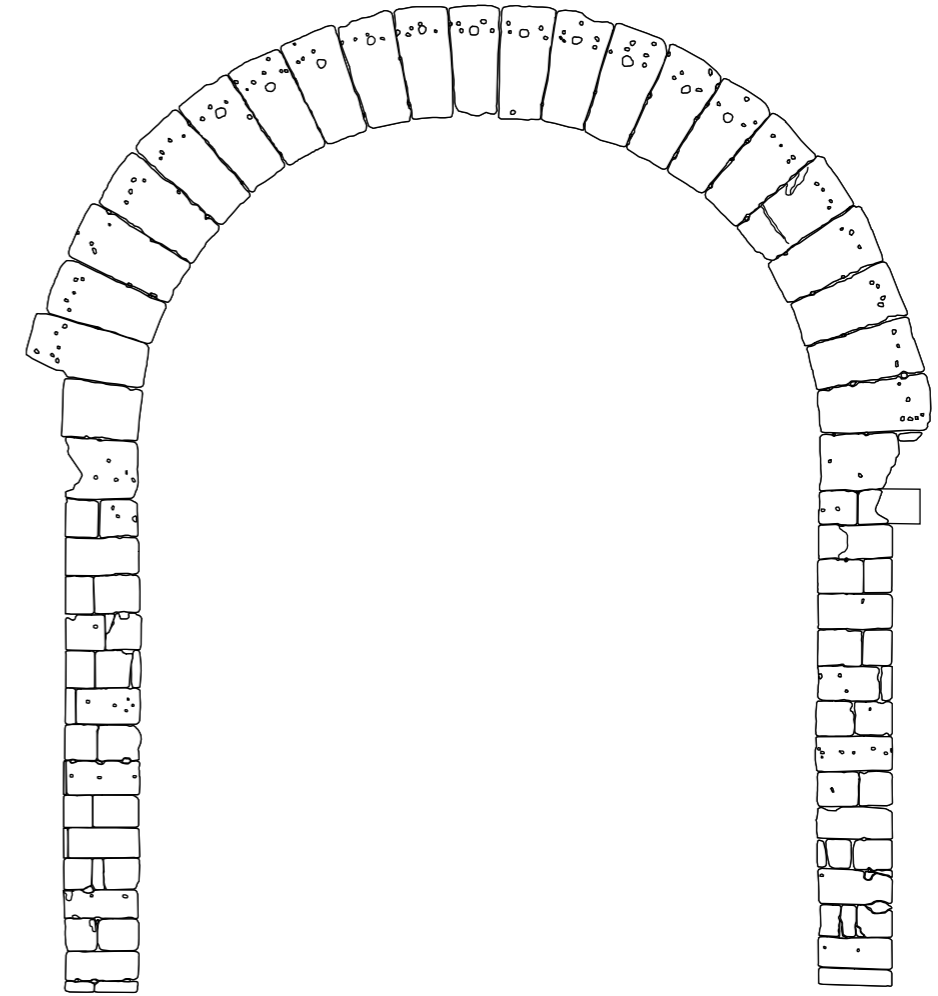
Levantamiento arquitectónico del Arco de Trajano (Lado S). Escala 1:100
